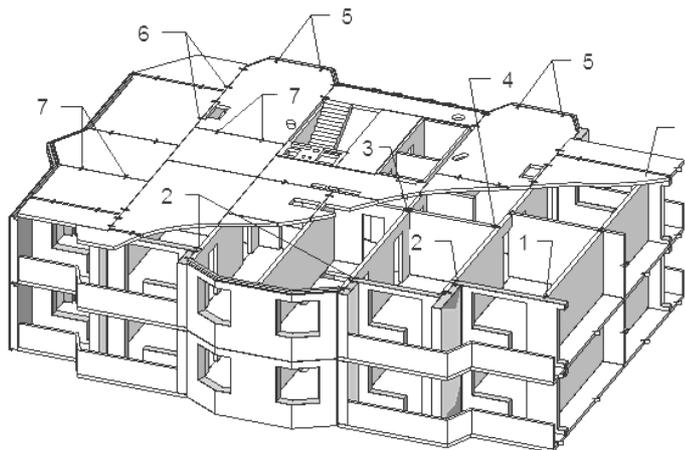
Схема расположения связей в крупнопанельном здании
